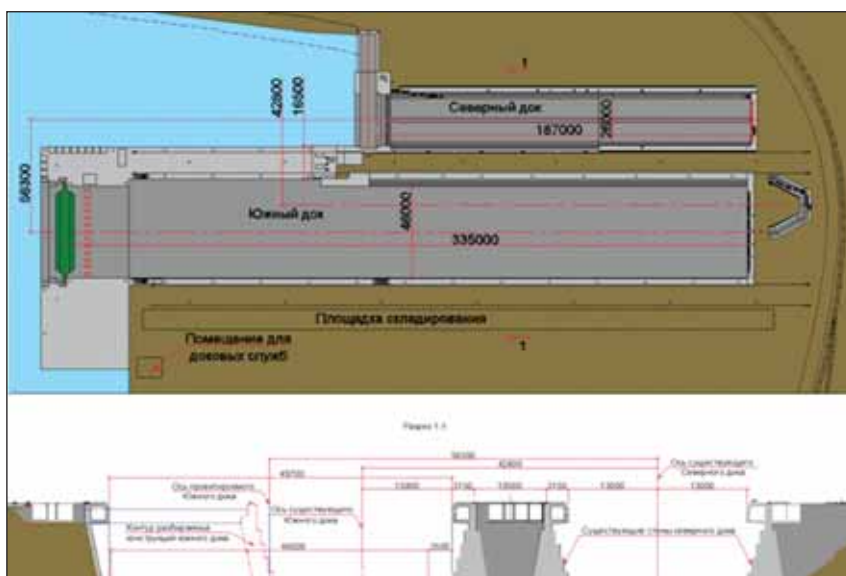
Реконструкция доков по варианту 1. План и поперечный разрез
